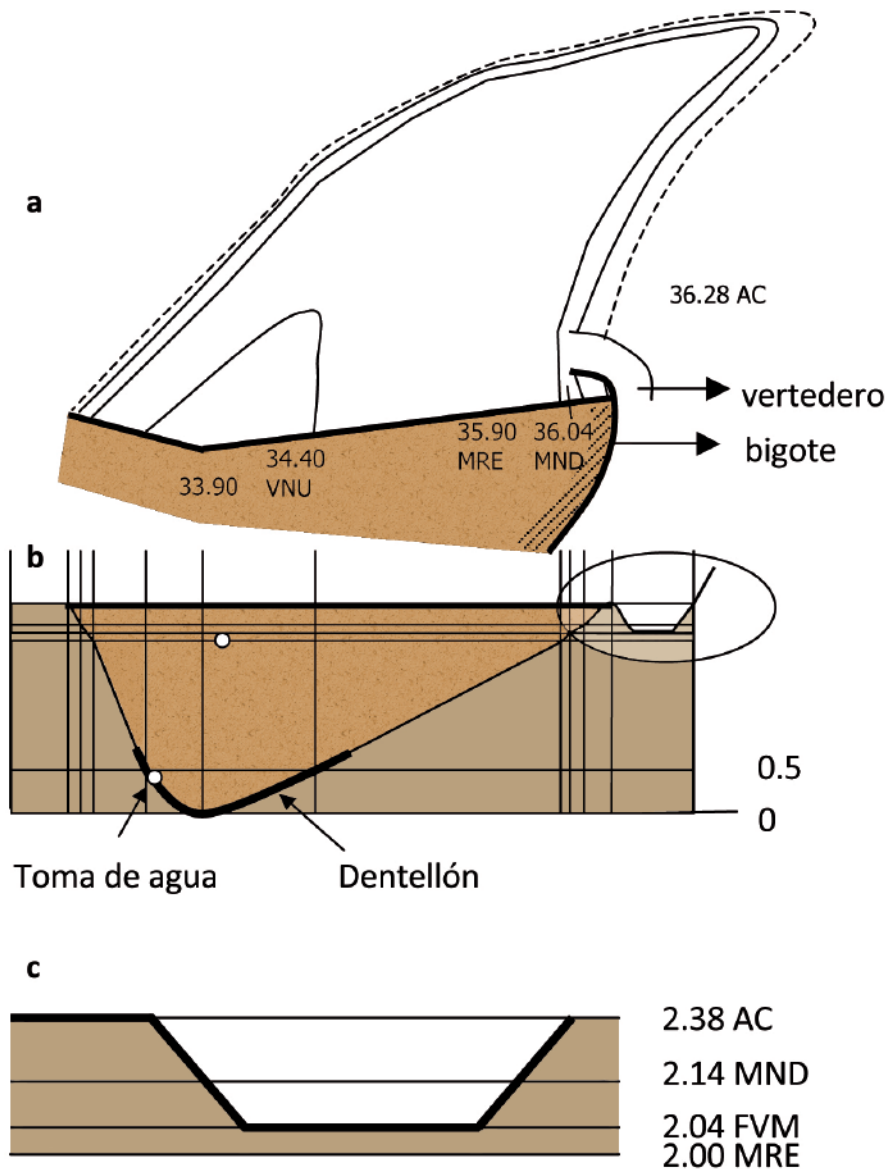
a. Vista en planta del lago y el eje de la cortina, b. perfil longitudinal de la cortina y c. detalle del vertedero.
